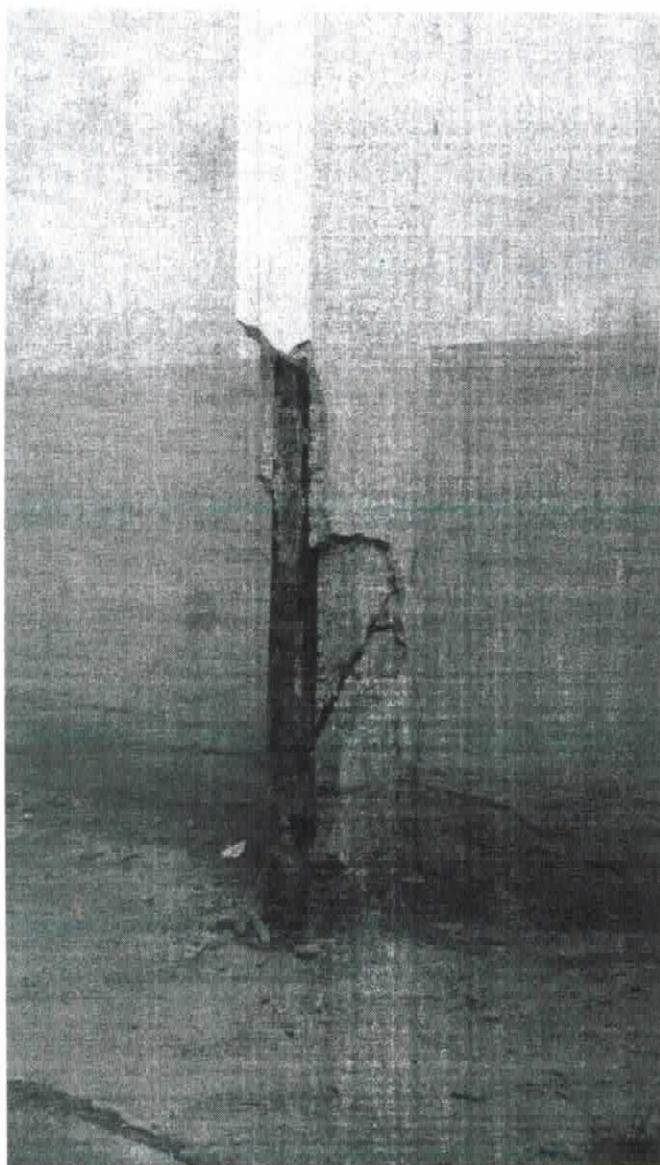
Pilar com estrutura metálica exposta e danificada por corrosão e compressão.
